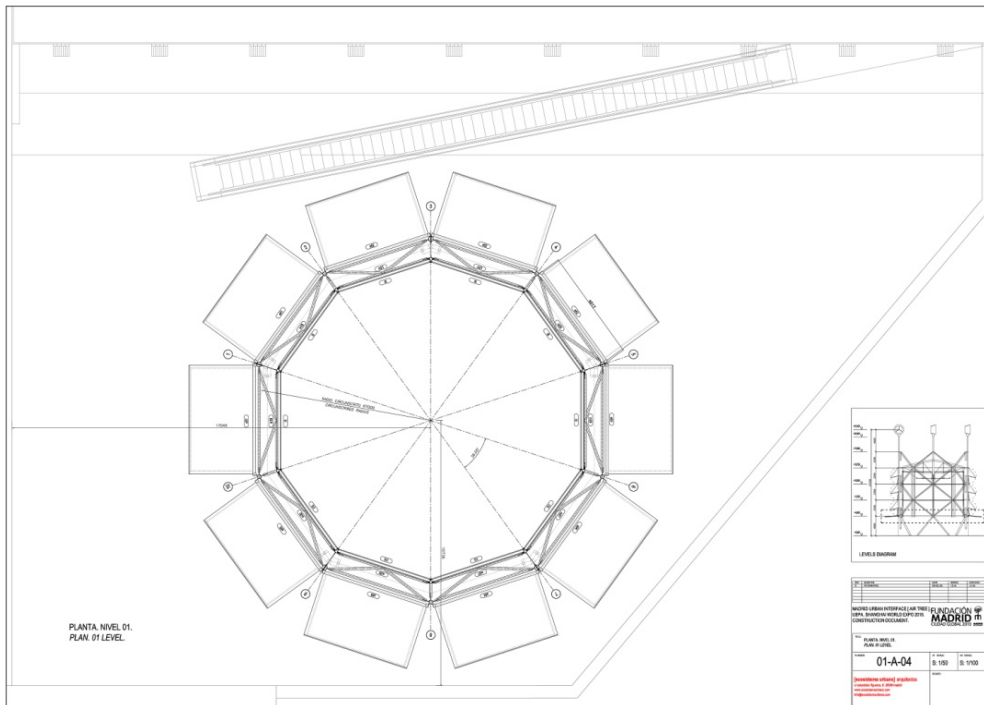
Plano de planta nivel 1. Fuente: Ecosistema Urbano
